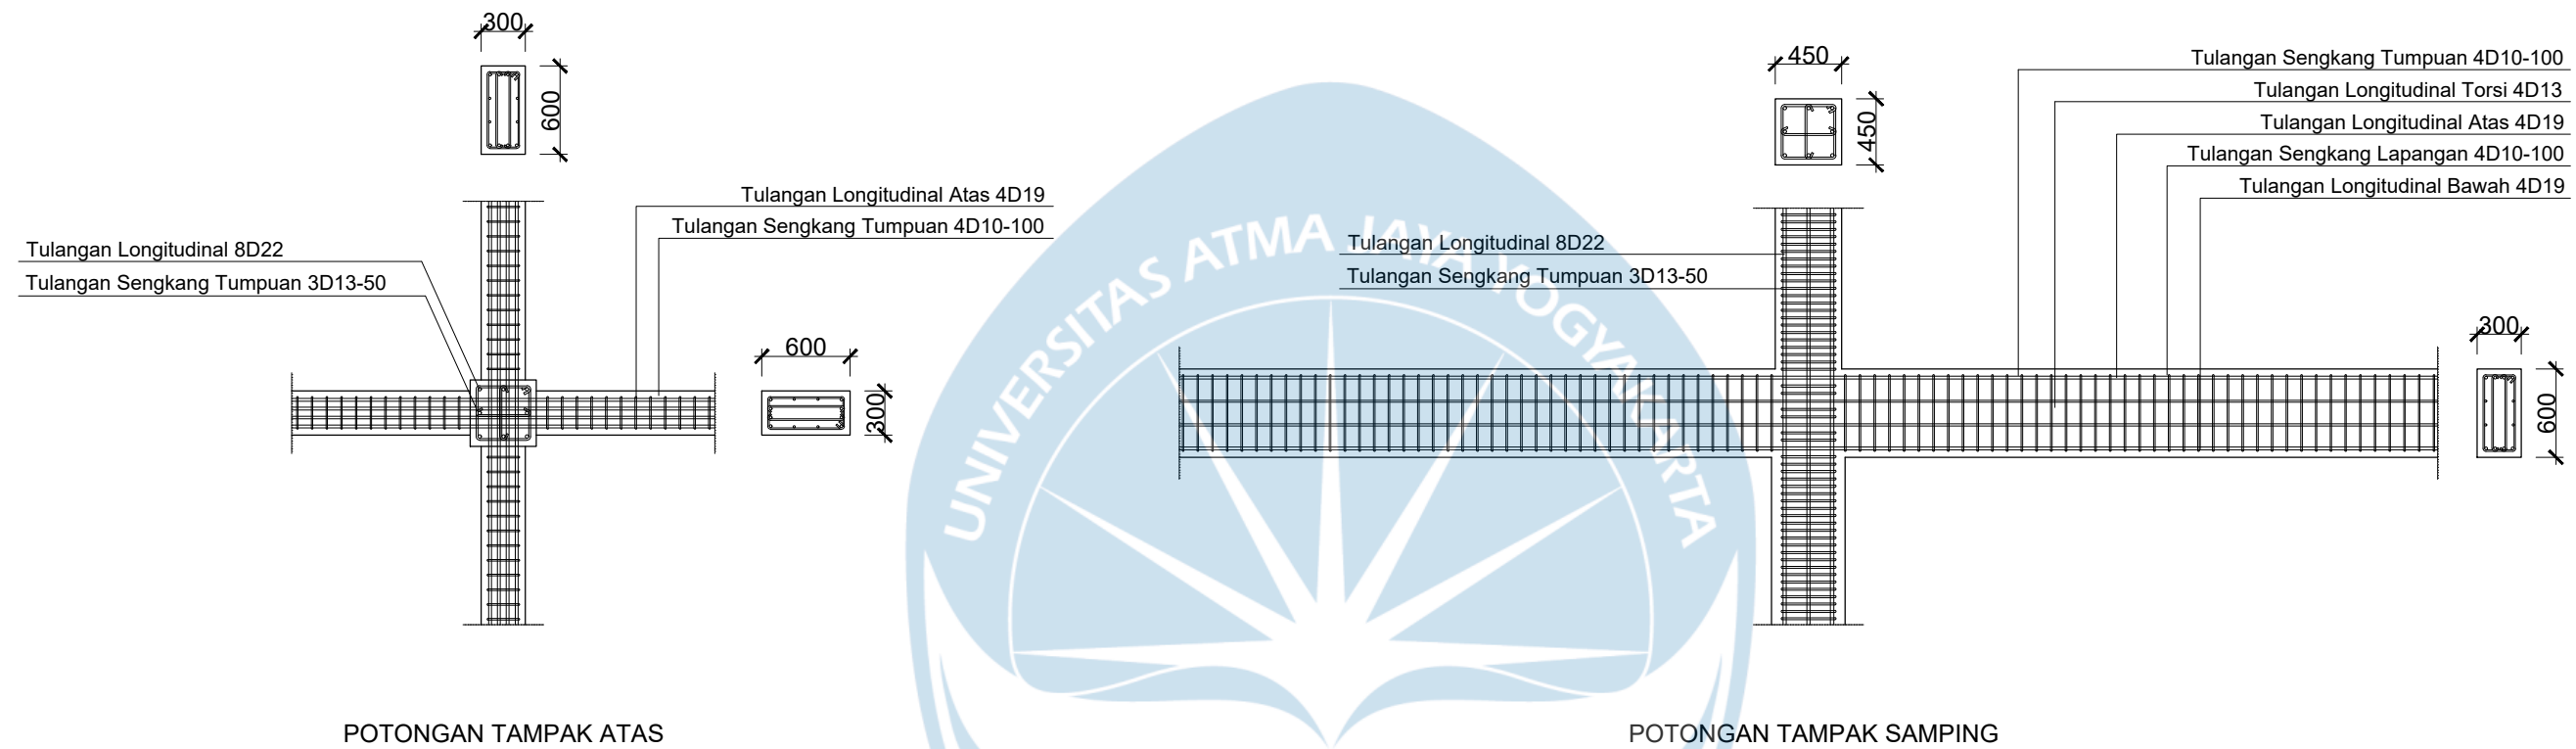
DETAIL HUBUNGAN BALOK B1 & KOLOM K1
